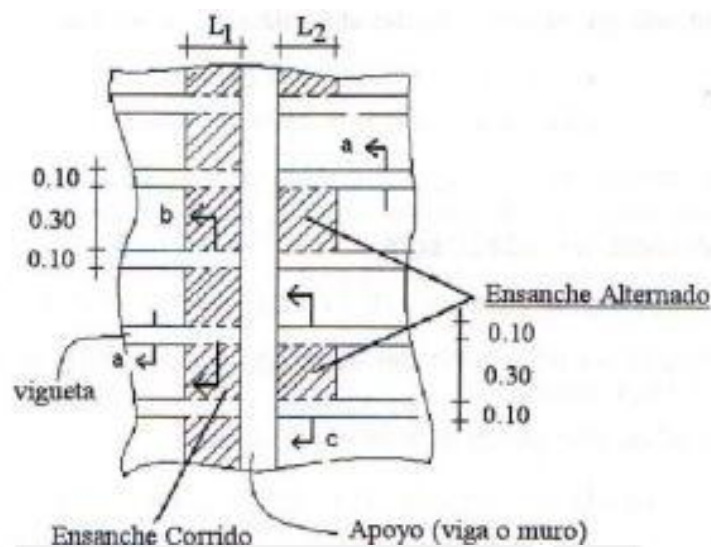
Detalle de ensanche alternado y ensanche corrido.
